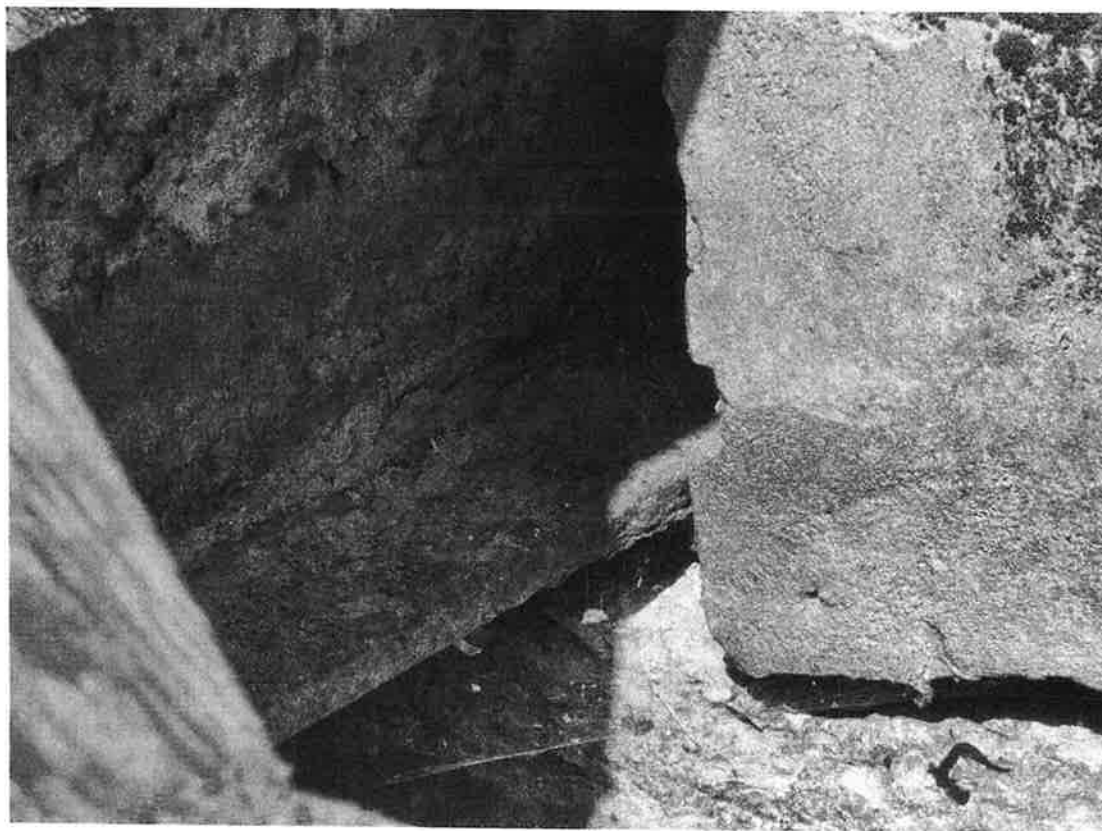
Zanieczyszczona przestrzeń podłożyskowa filara nurtowego
